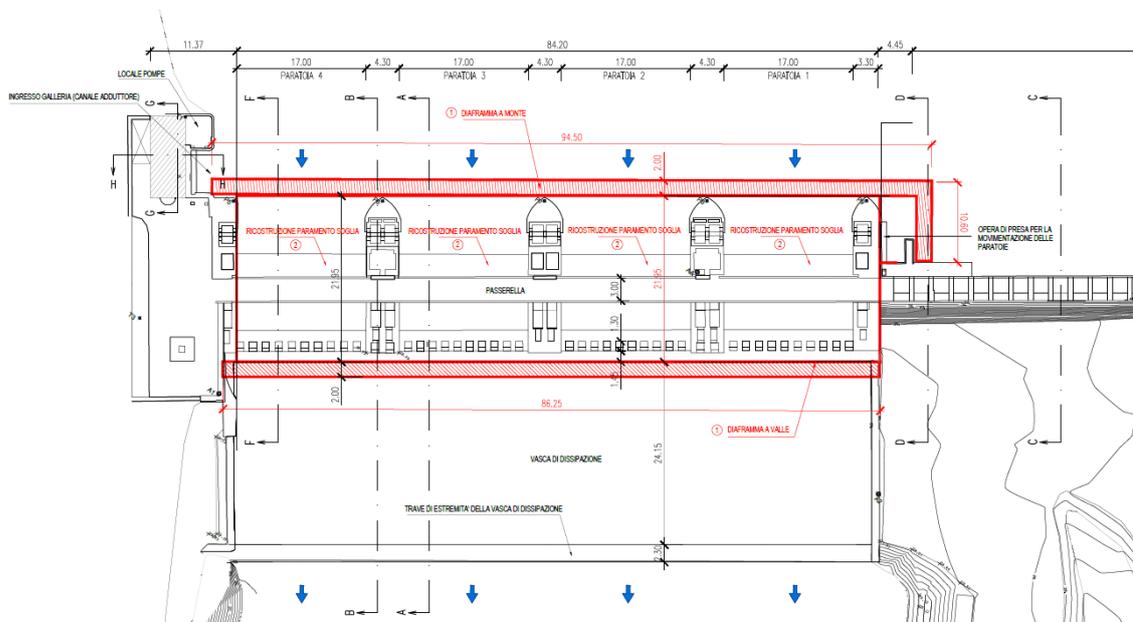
PLANIMETRIA UBICAZIONE DEGLI INTERVENTI
